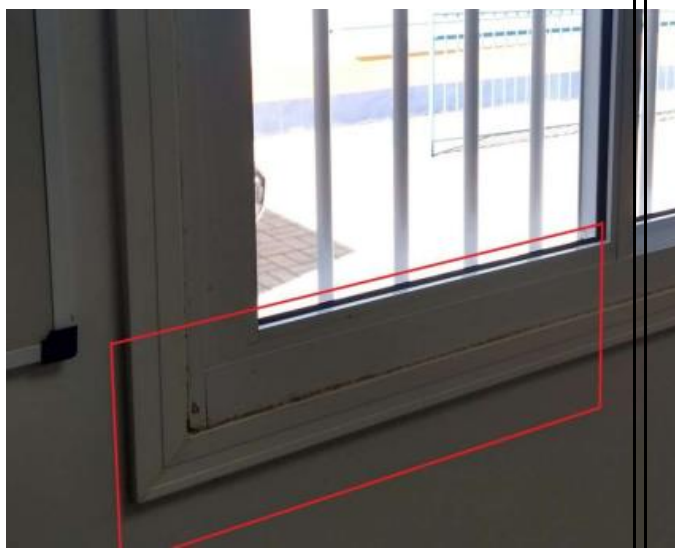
Janela com infiltração - CIGERD Xanxerê.
